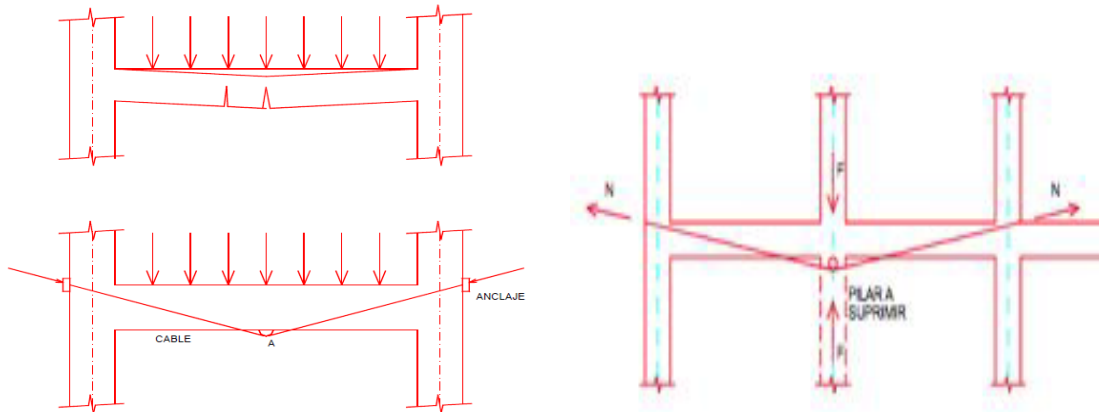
Recuperación y refuerzo de una viga dañada, Supresión de pilares mediante el uso de cables de postesado exterior en estructuras de hormigón armado. (Casas Rius, 2012)
